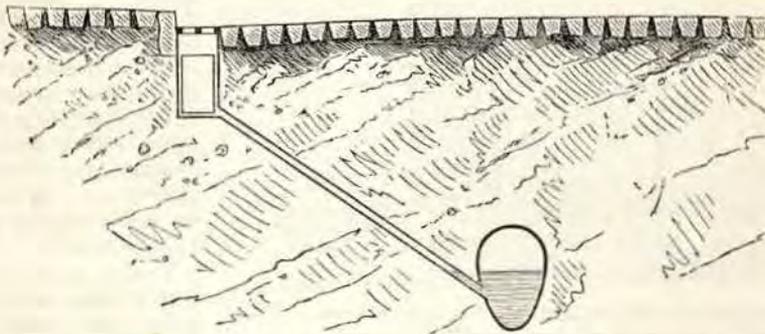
Sezione di un canale stradale e bocca di comunicazione col pavimento della strada, secondo il sistema di canalizzazione inglese.
